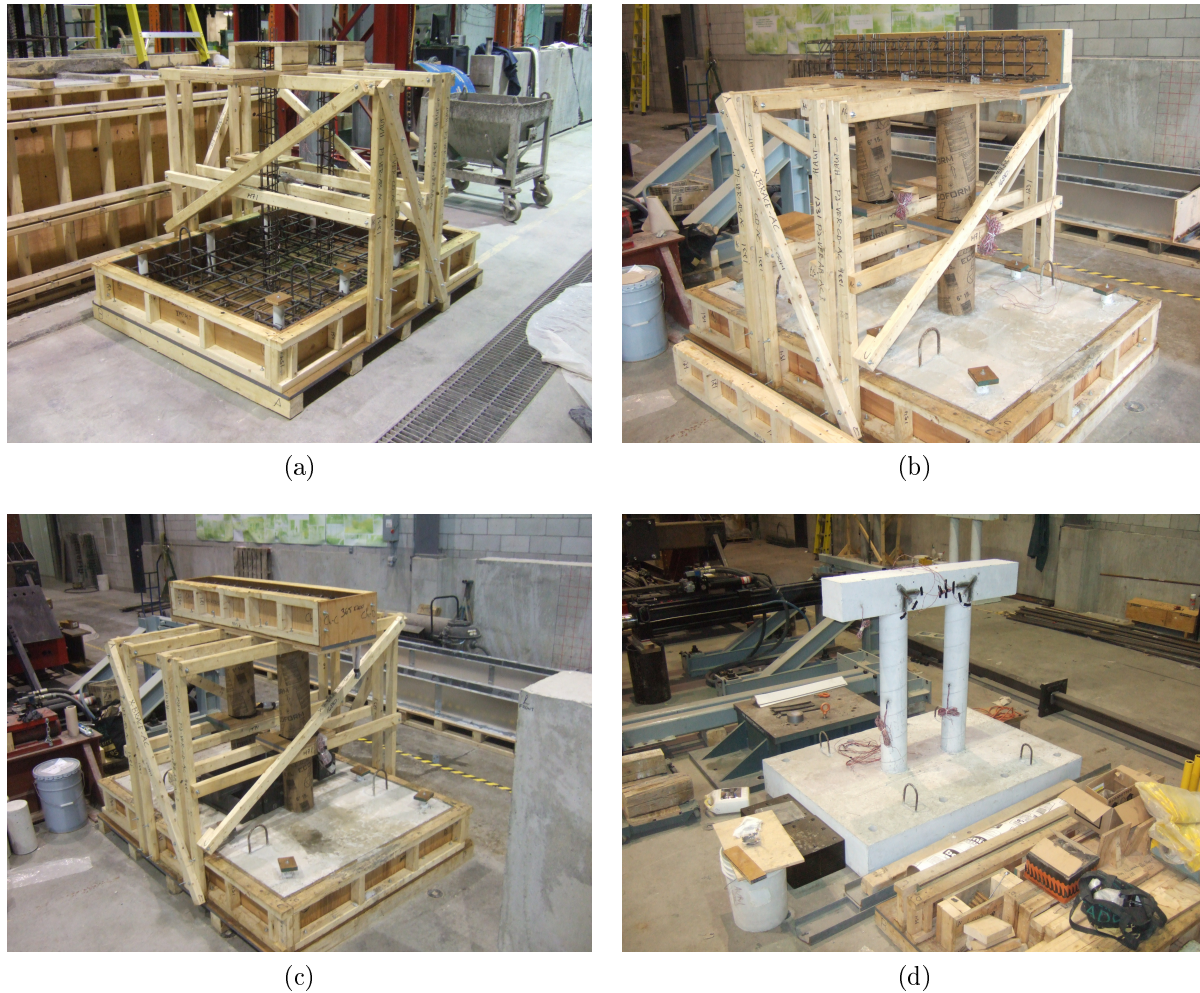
Étapes de construction de la pile 02 : (a) ferraillage de la semelle et des poteaux, (b) semelle coulée et ferraillage du chevêtre, (c) coffrage complété, (d) pile terminée
